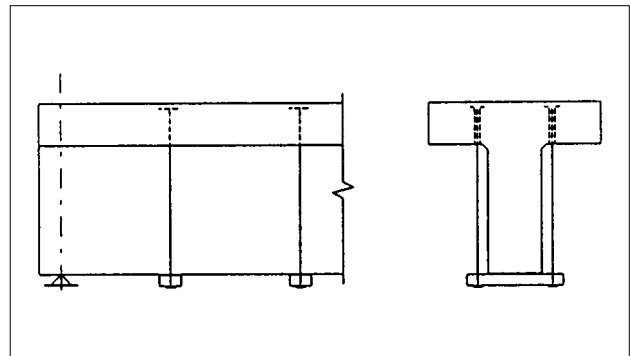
Renforcement au cisaillement au moyen de câbles verticaux.
